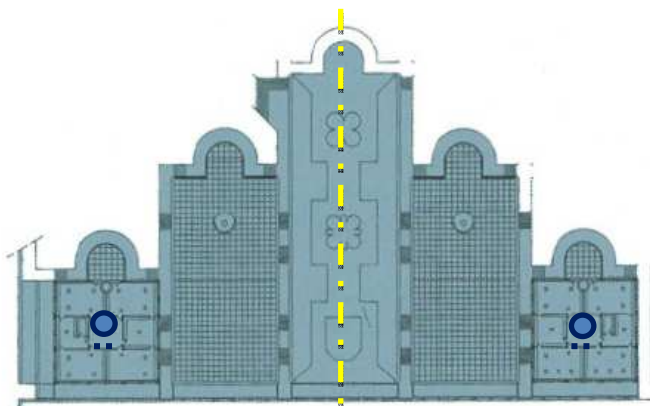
Planta do piso 2 \_ Escola Secundária José Gomes Ferreira, Benfica, (1976|1980)
